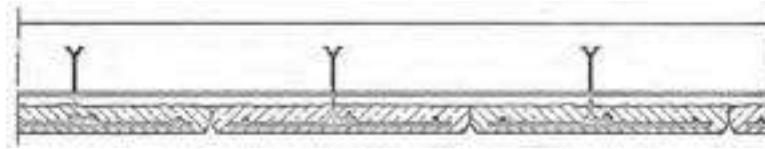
Zeichnung einer Streifen-Elementdecke mit S-Träger (aus [21])
